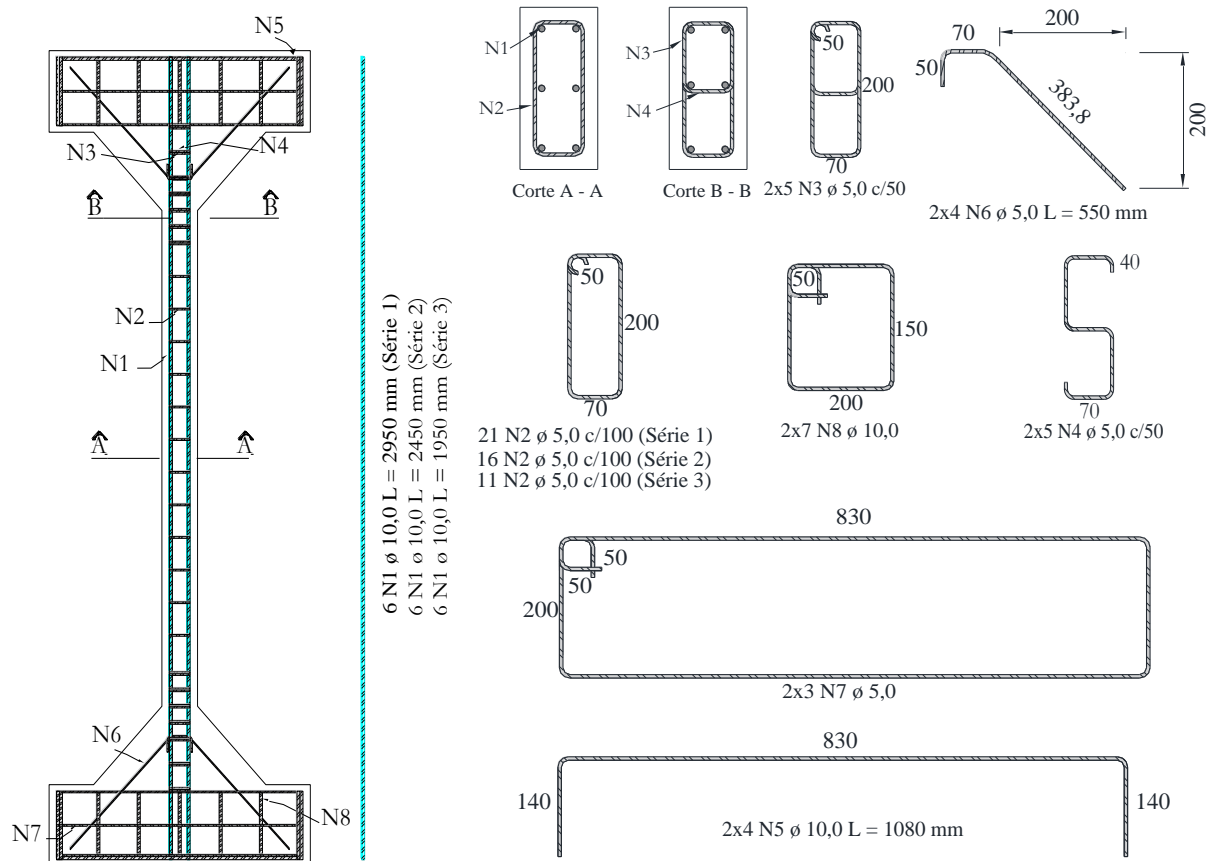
Detalhamento das armaduras dos pilares (MELO, 2009).
